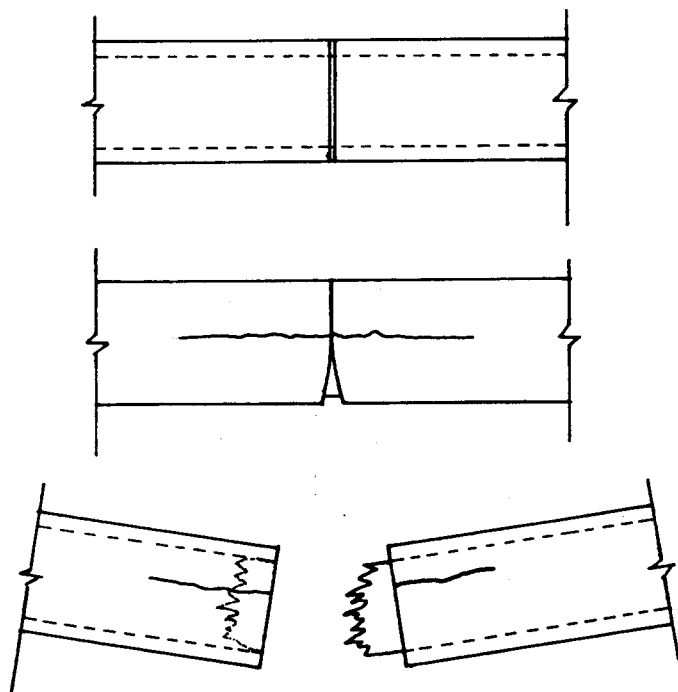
Esquema de la rotura de las vigas 1 y 2
